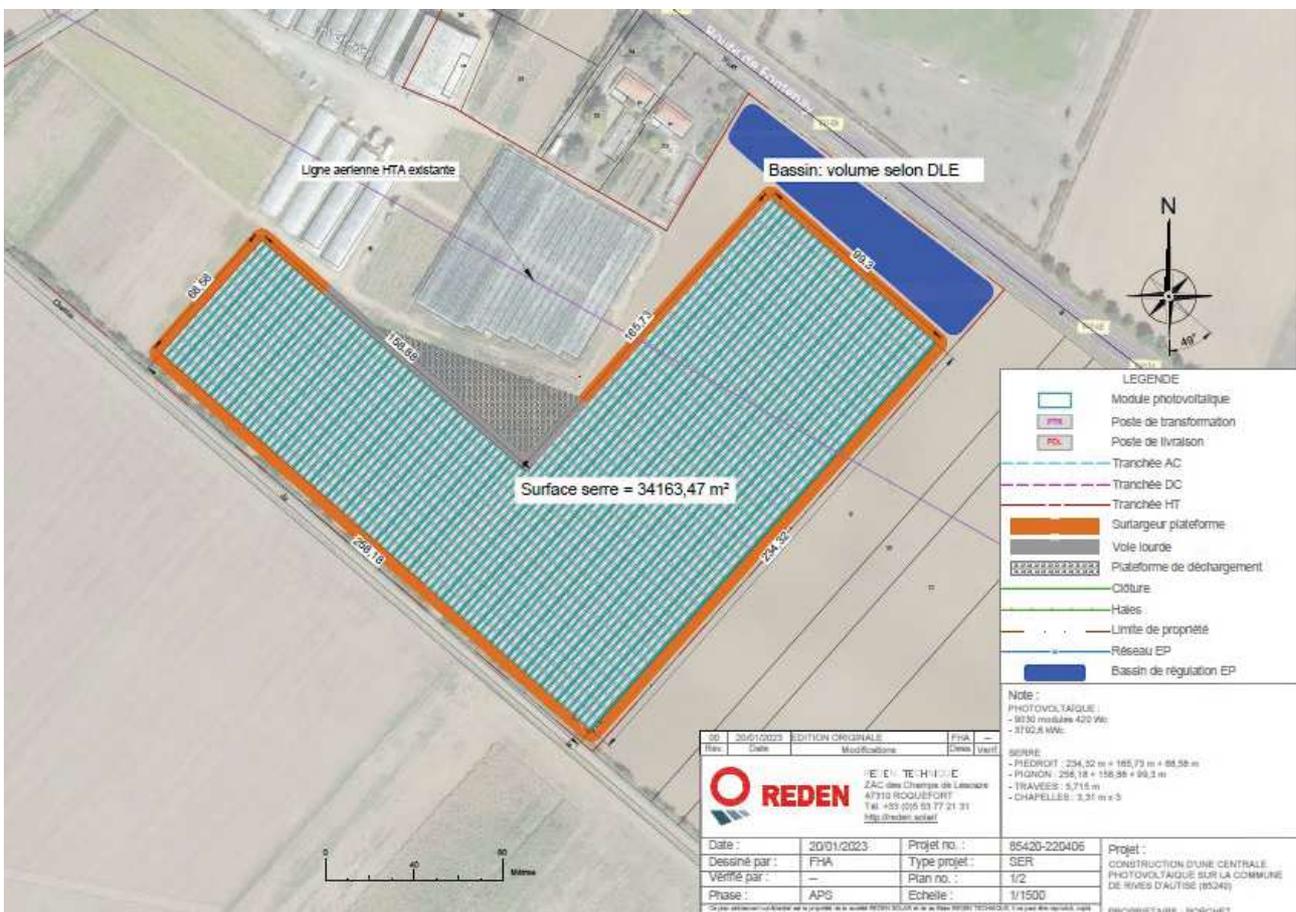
Implantation du projet : plan de la serre (Source : REDEN, 2023).
